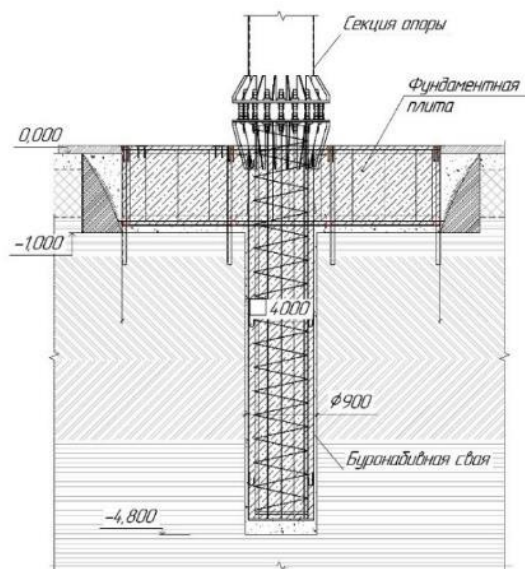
Пример схемы устройства фундамента с буронабивной свай
